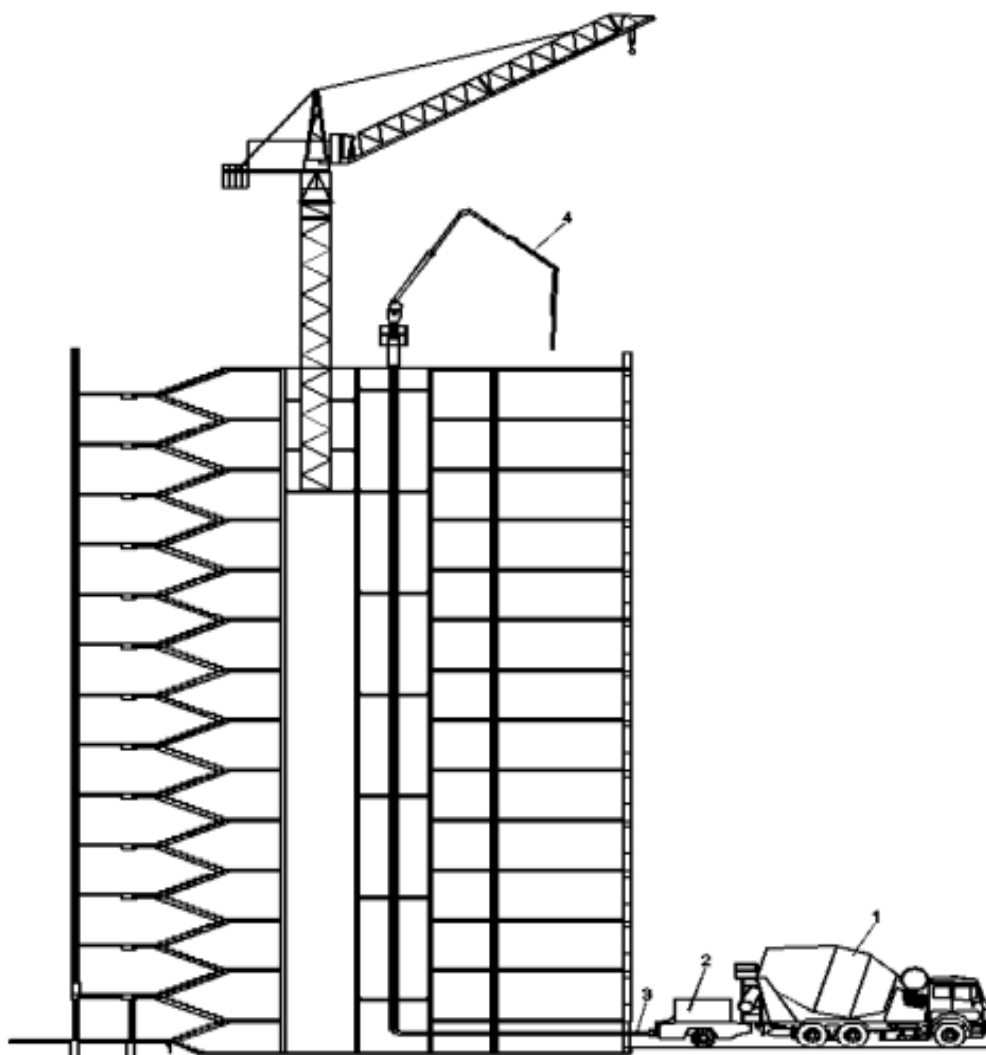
Схема подачи бетонной смеси бетононасосом: 1 — автобетоносмеситель; 2 — бетононасос; 3 — бетоновод; 4 — автономная распределительная стрела
